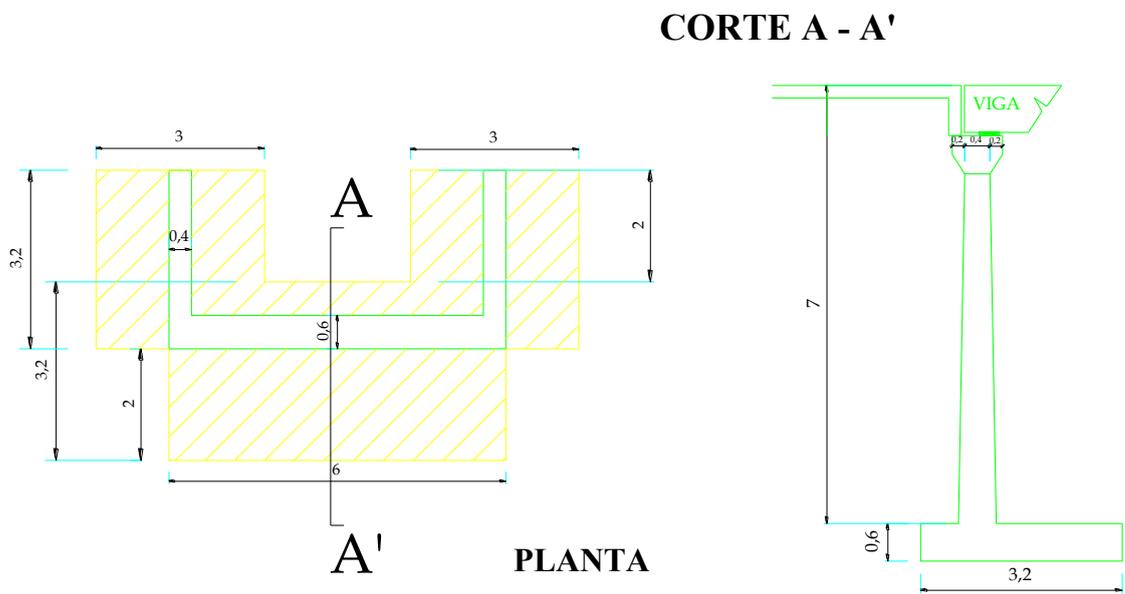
DETALLE DE LOS ESTRIBOS A UTILIZARSE EN LA AMPLIACIÓN.
